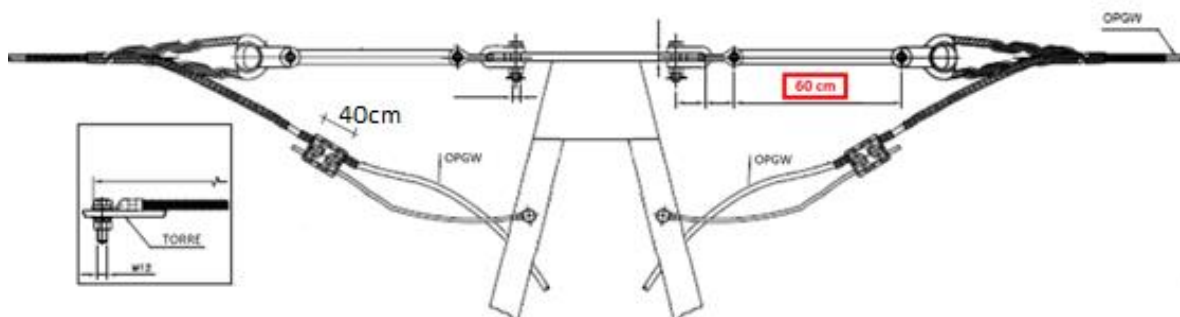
Conjunto de amarre bajante de OPGW para ser instalado en los 2 extremos de la torre
